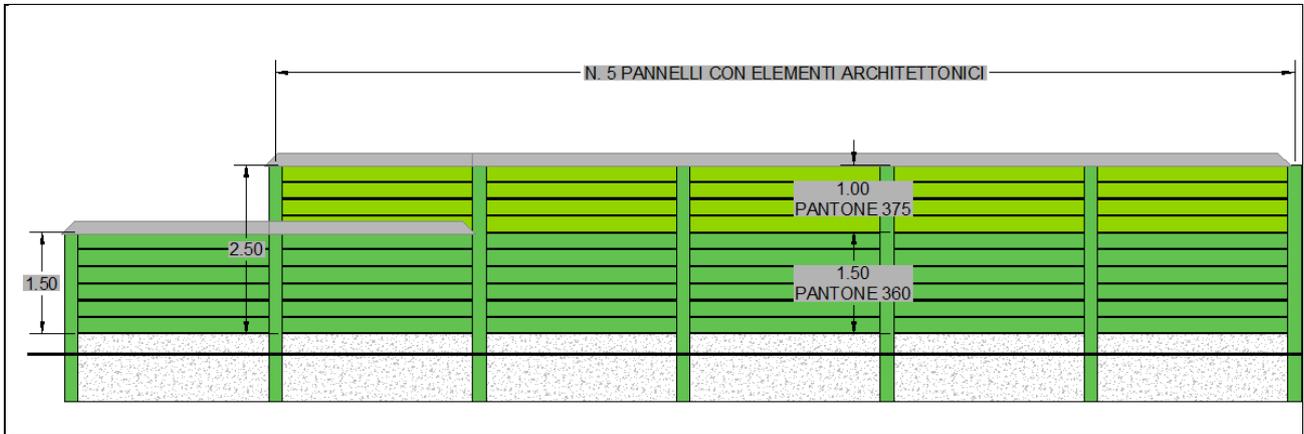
PROSPETTO TIPO ELEMENTI ARCHITETTONICI PER BARRIERA ANTIRUMORE H 3,5 M
